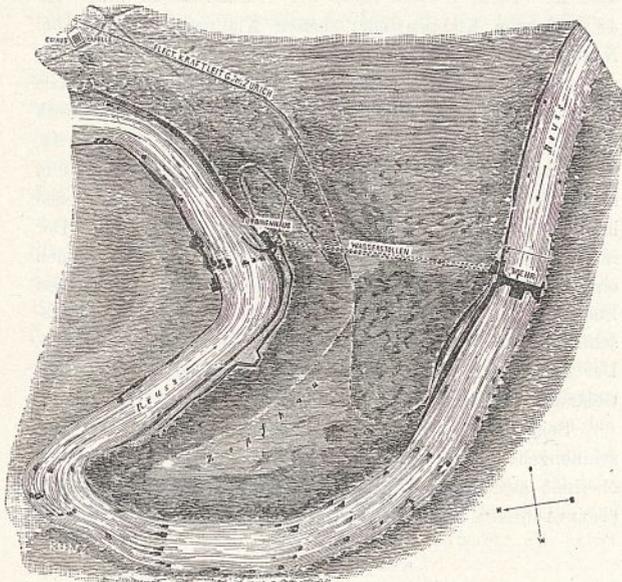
Zufikon-Bremgarten. Lageplan 1:10000.
